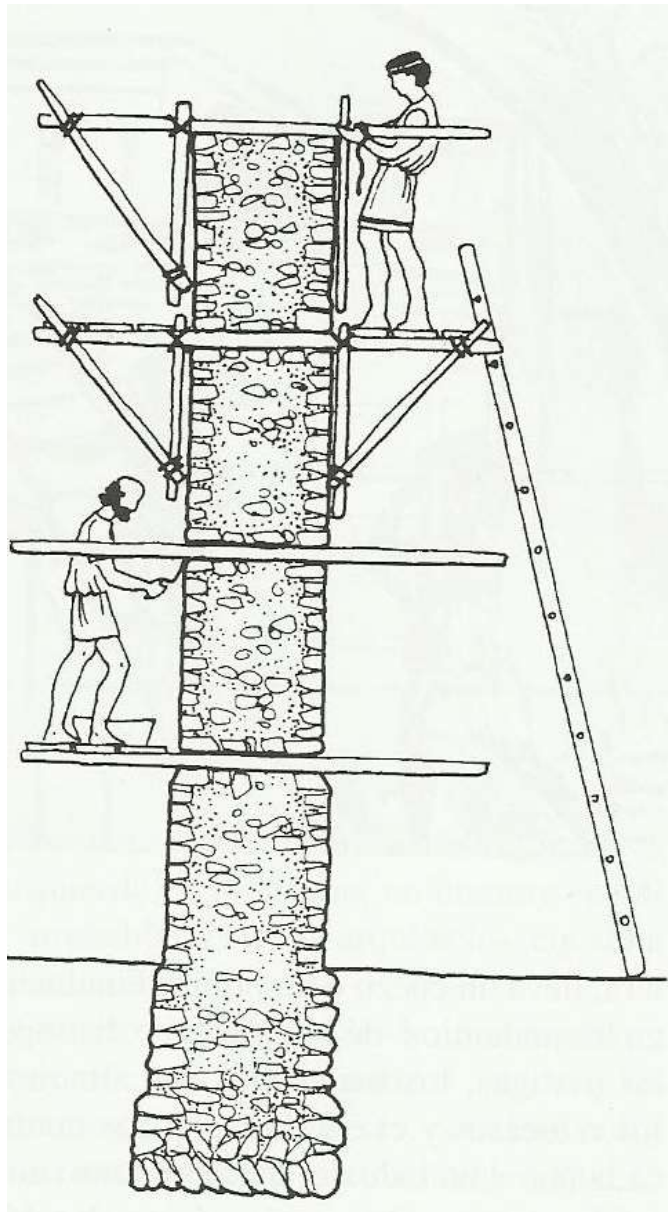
Detalle de la construcción de un muro con andamios de báscula (Imagen 183 en Adam 2002:88)).
